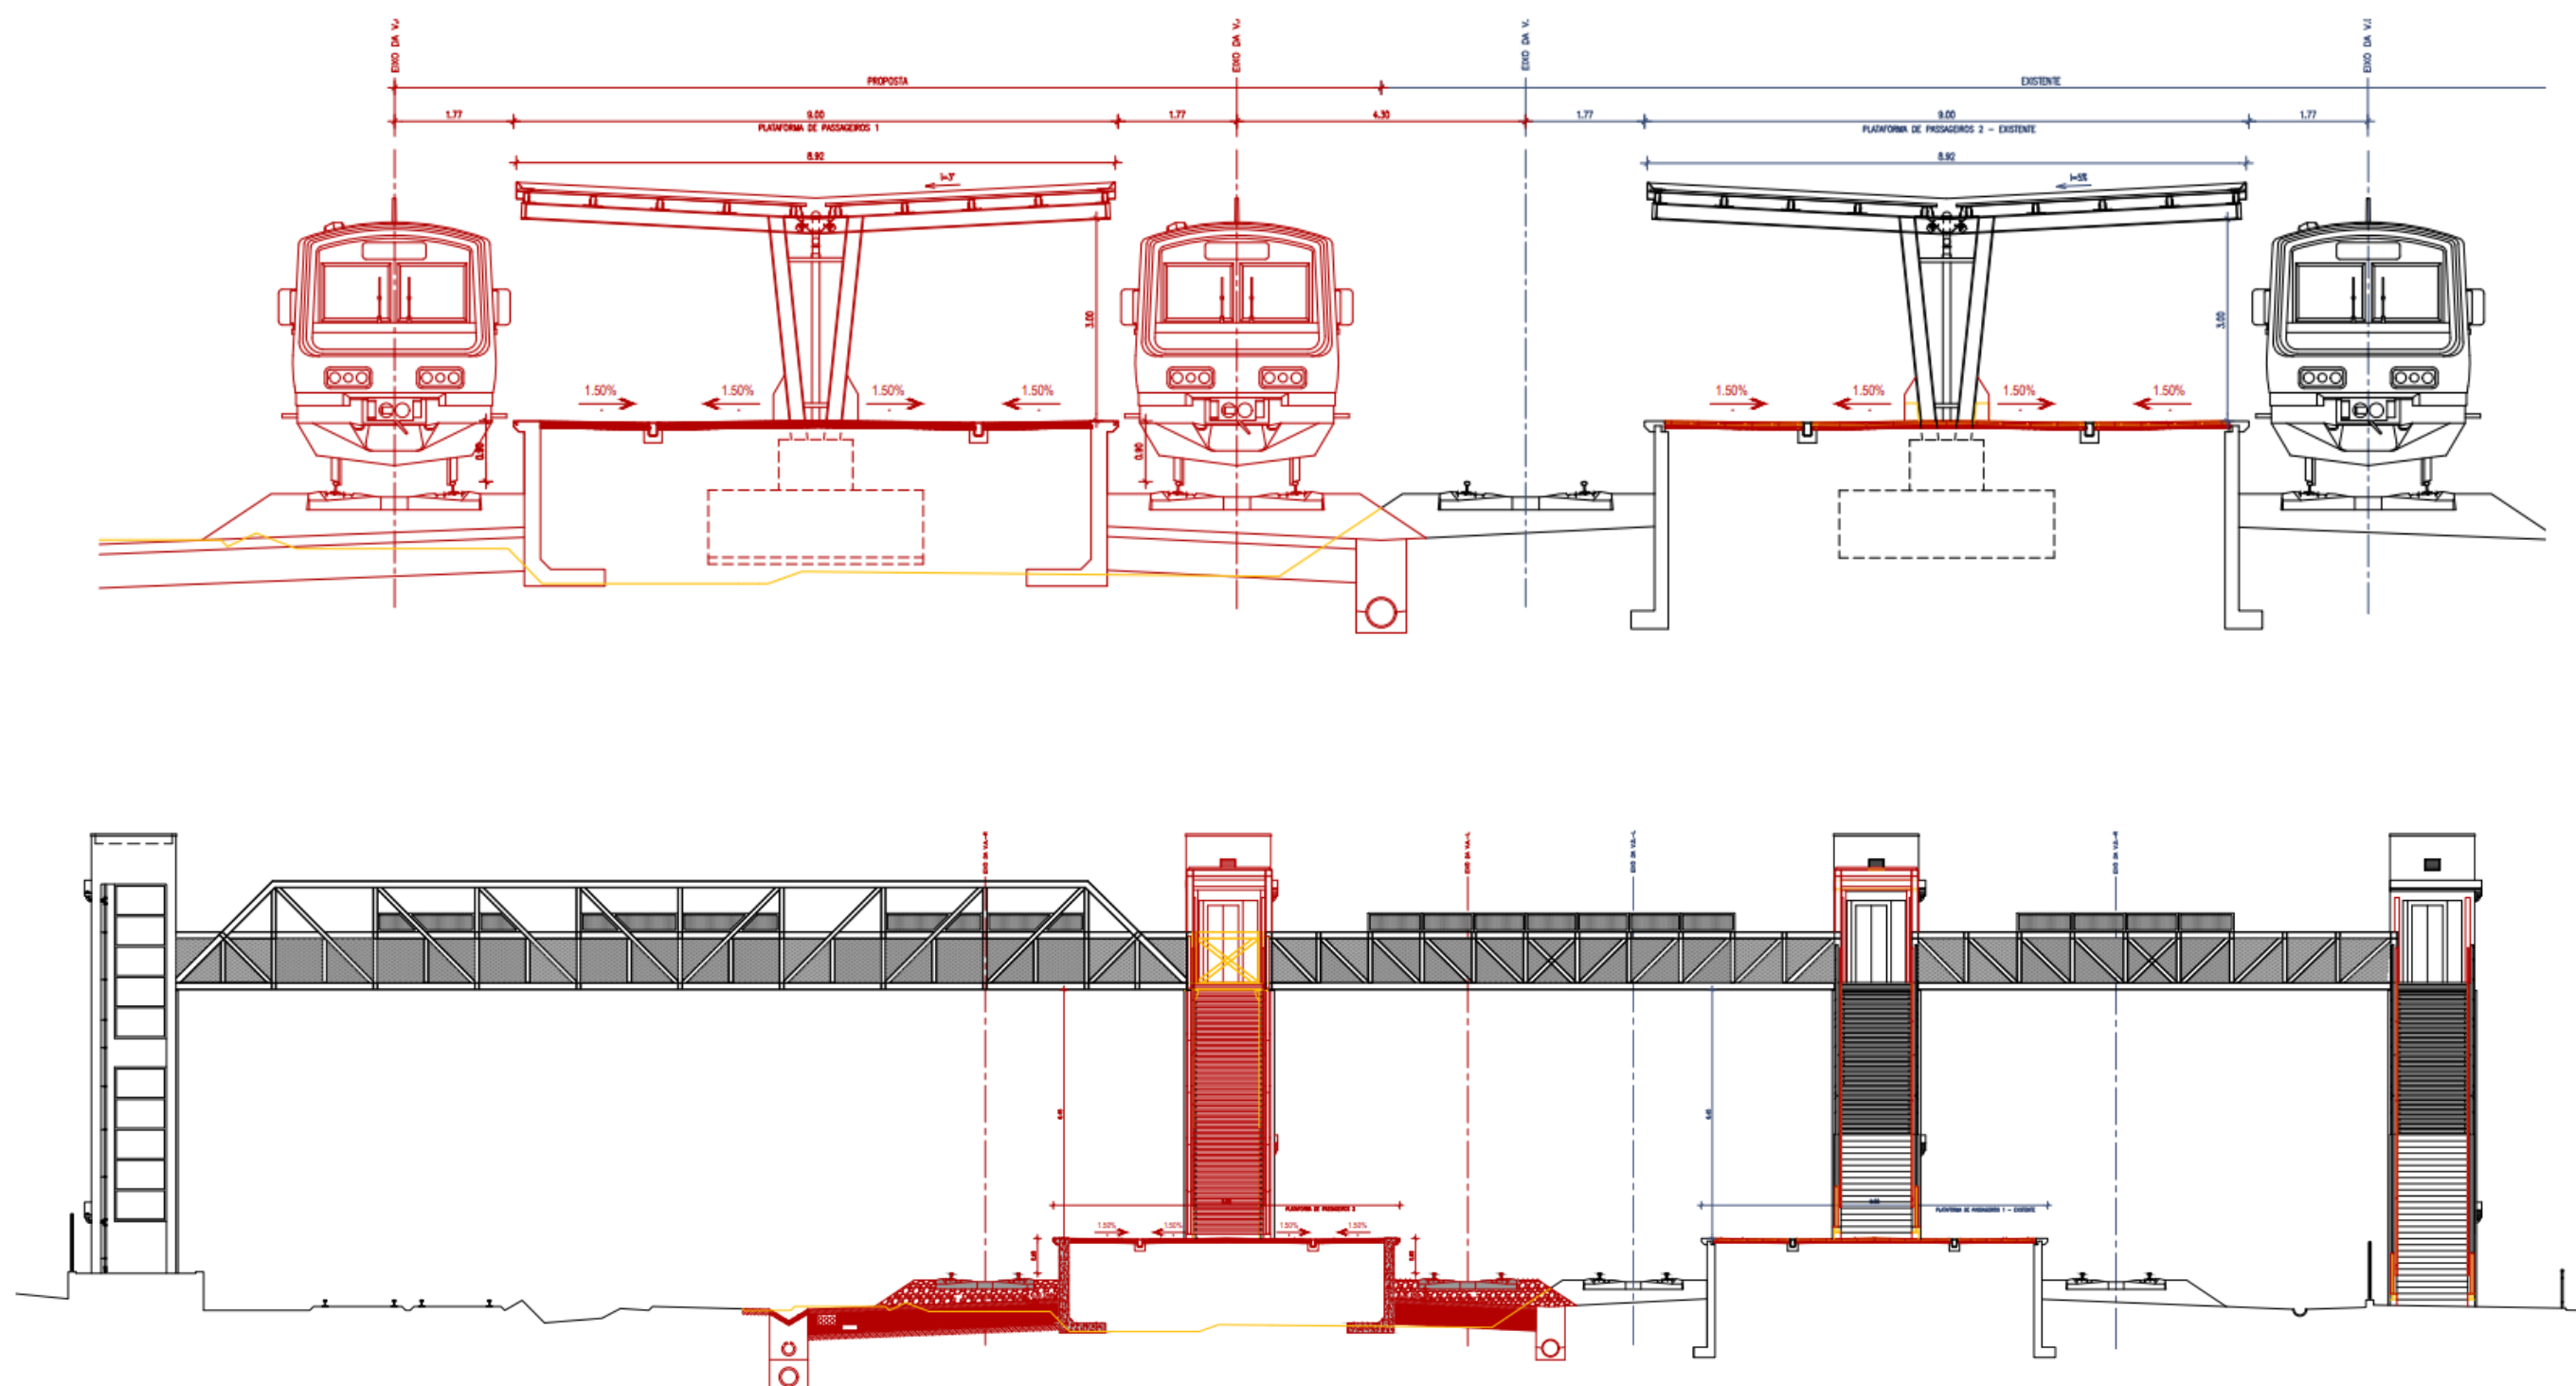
Perfil transversal com as alterações a executar, designadamente construção de nova plataforma do lado terra, na zona do Apeadeiro do Espadanal da Azambuja e na PSP (existente a demolir assinalado amarelo; a construir assinalado a vermelho)
